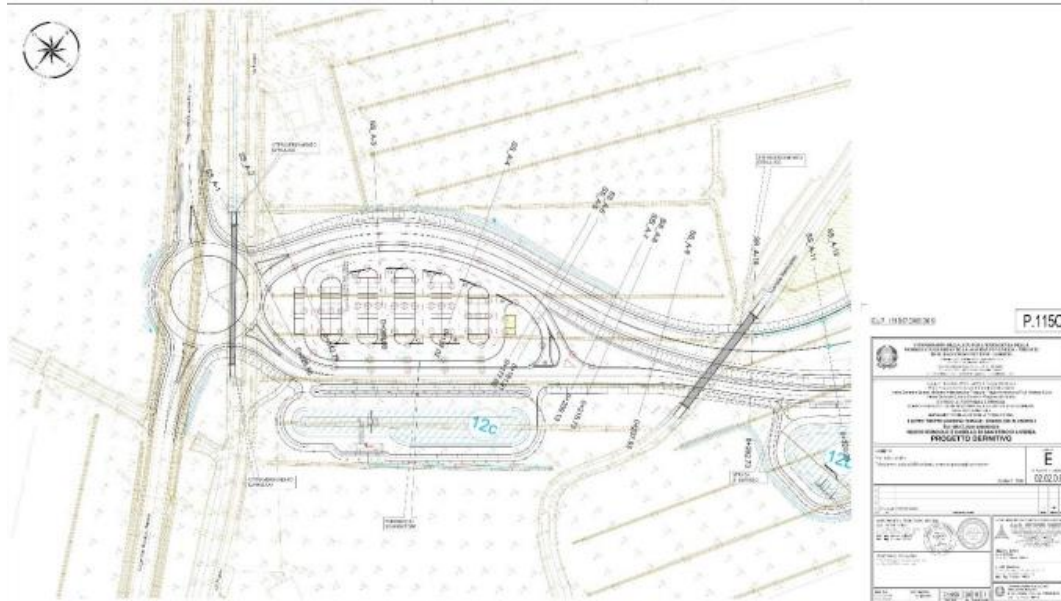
Estratto dalla planimetria tecnica collegamento con la viabilità ordinaria (var. SP 59), rotatoria e parcheggio scambiatore (Elab. E.02.02.0.0)
